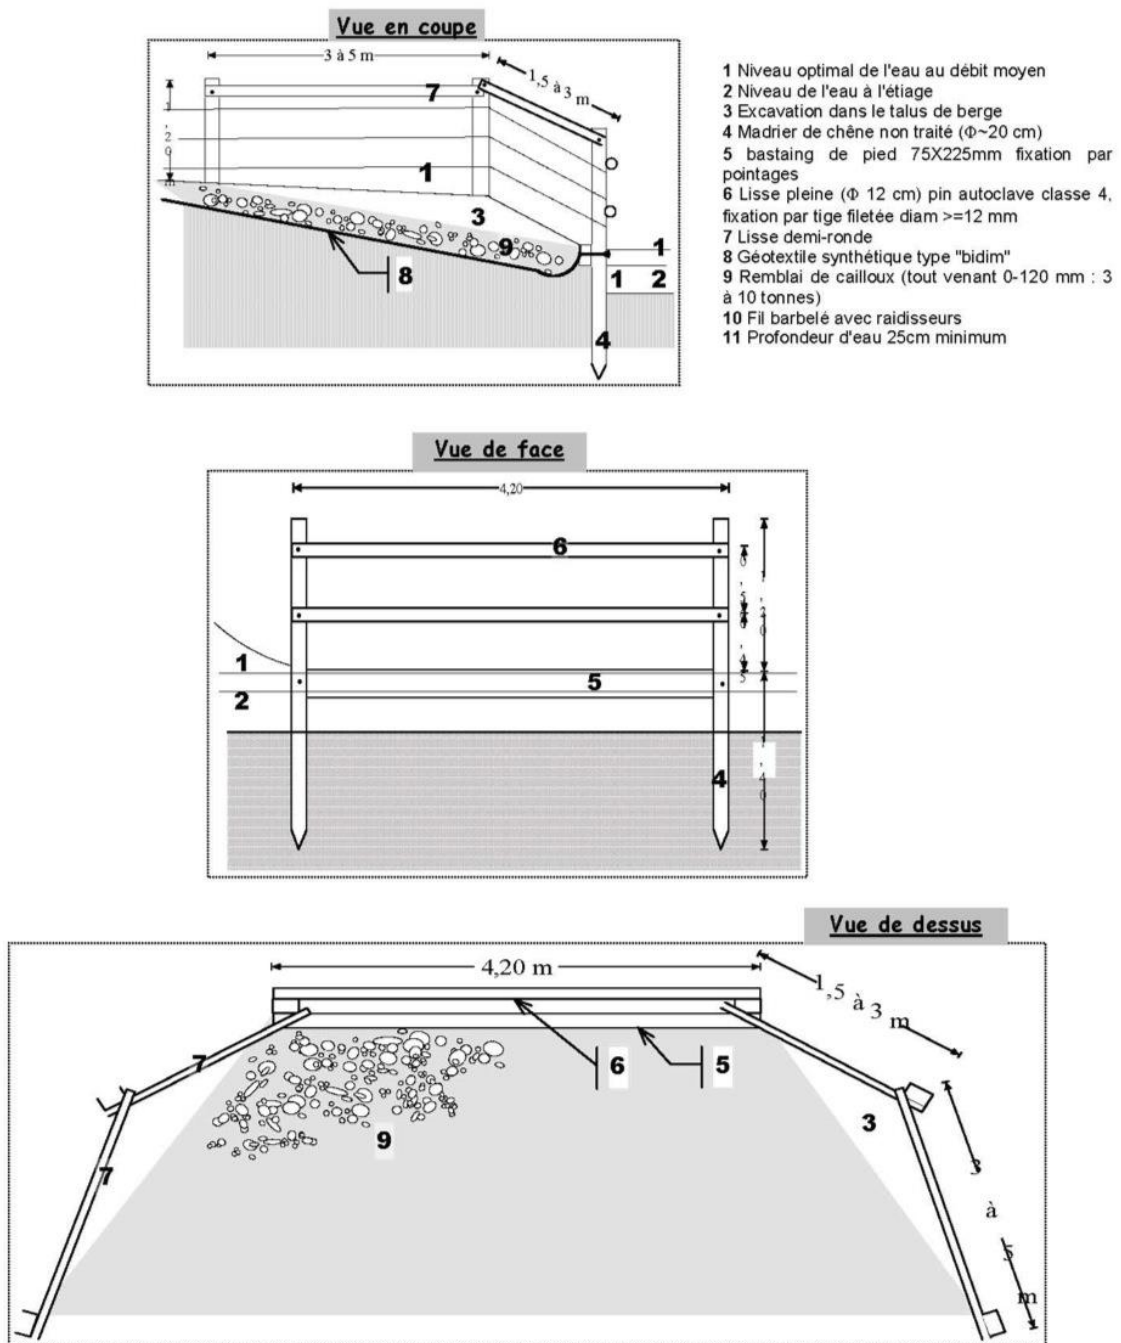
Plans et coupes d'un abreuvoir aménagé
